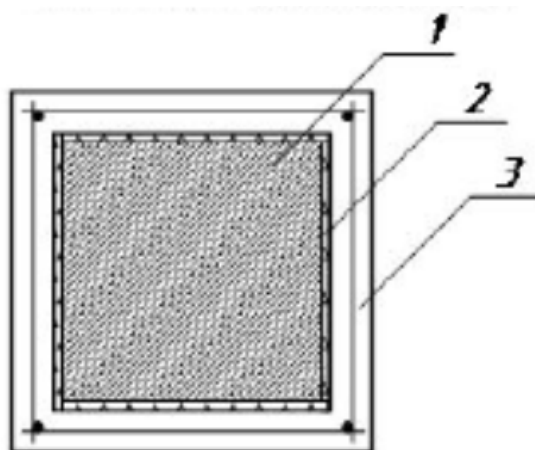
Железобетонная обойма с продольной и поперечной арматурой в виде замкнутых хомутов и слой адгезионной обмазки из жидкого стекла с добавлением цемента: 1 – железобетонная колонна, 2 – обмазка из жидкого стекла с добавлением цемента, 3 – железобетонная обойма
